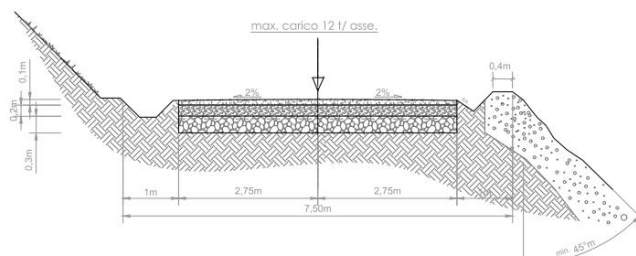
Sezione stradale tipo con scarpata (mezza costa)
